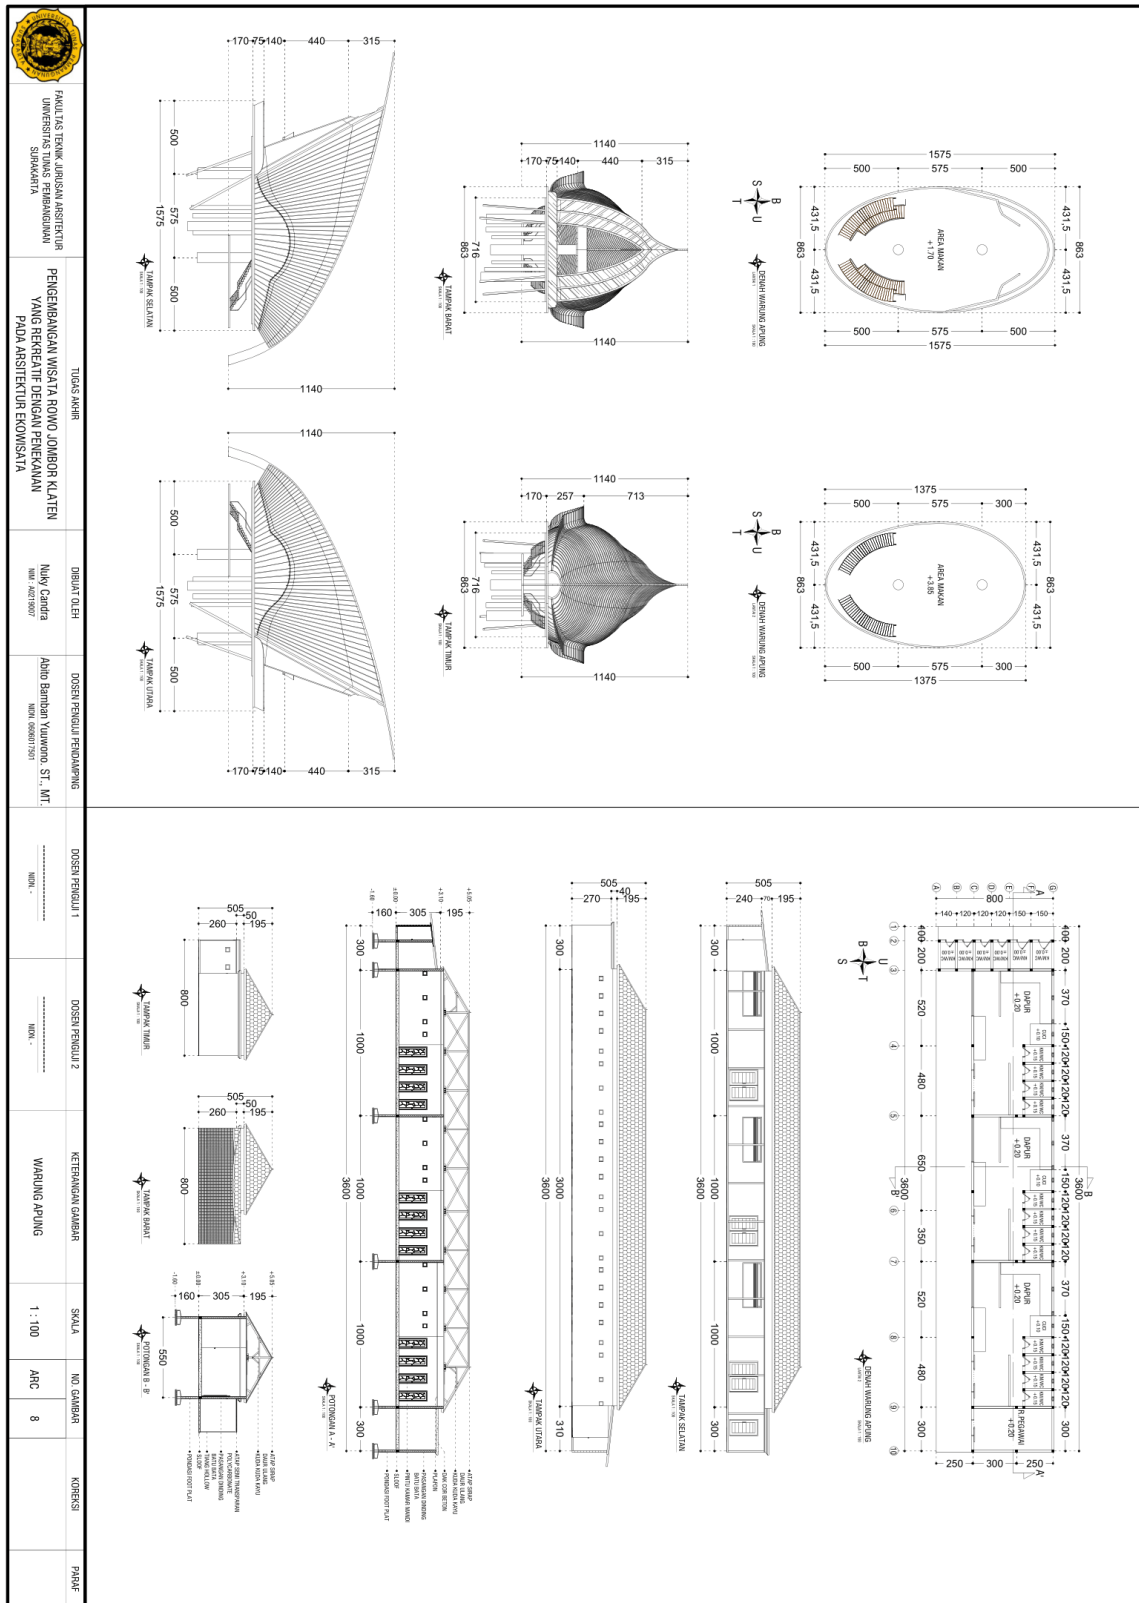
Gambar Tampak Dan Potongan Bangunan UMKM
